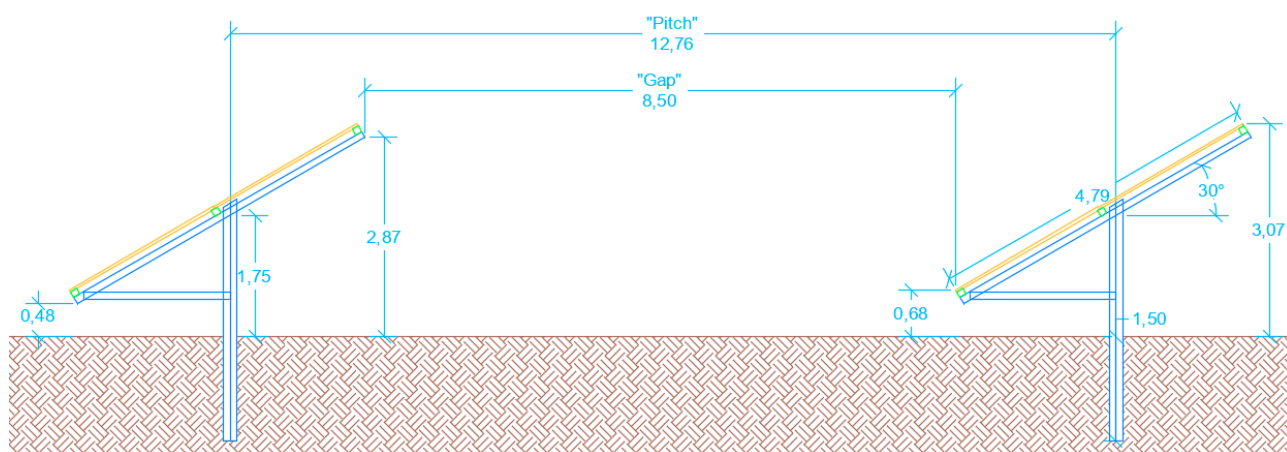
Vista delle strutture fotovoltaiche in sezione.
